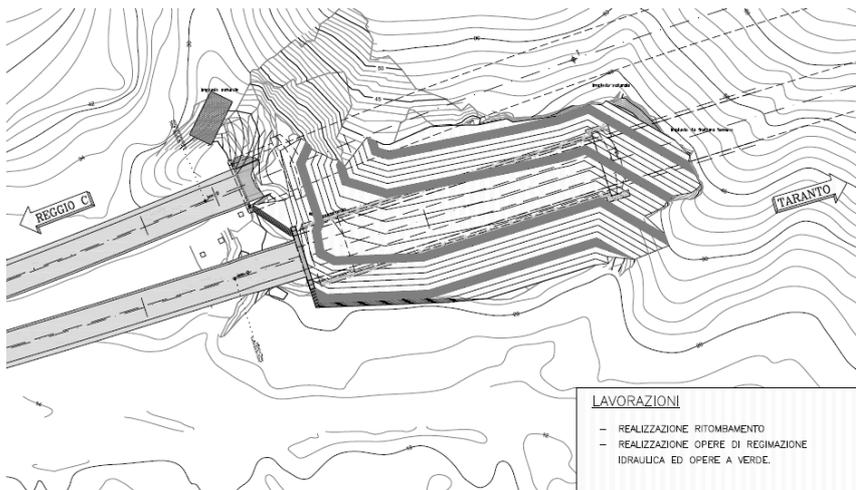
Galleria Palizzi – Fase 3 sistemazione finale – Lato RC
